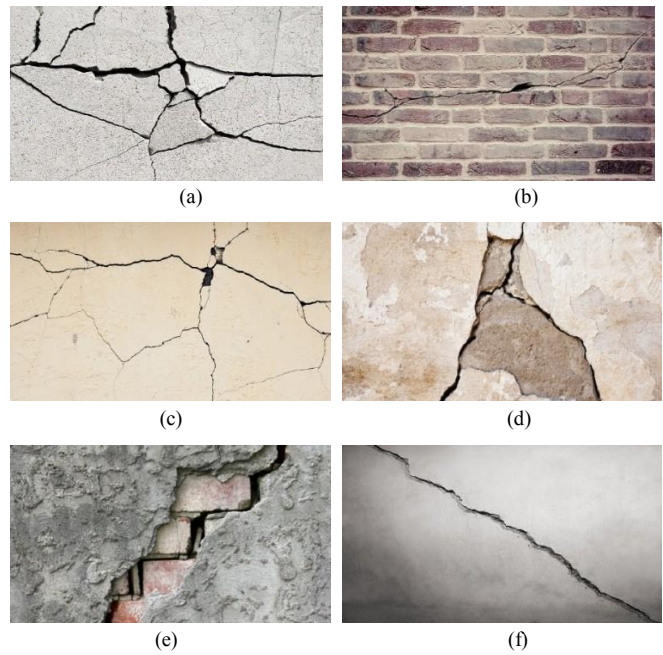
Imágenes de grietas utilizadas (a) Grieta en el centro del muro de carga (b) Grieta superficial en muro divisorio hueco (c) Grieta en muro de contención (d) Grieta en muro divisorio (e) Grieta diagonal en muro de contención (f) Grieta diagonal en muro divisorio
